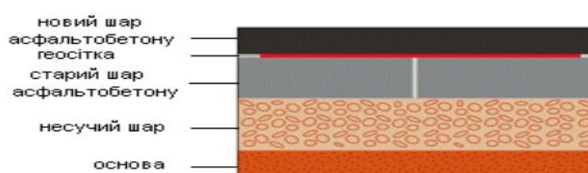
Армування асфальтобетону, покладеного на бетонне покриття
